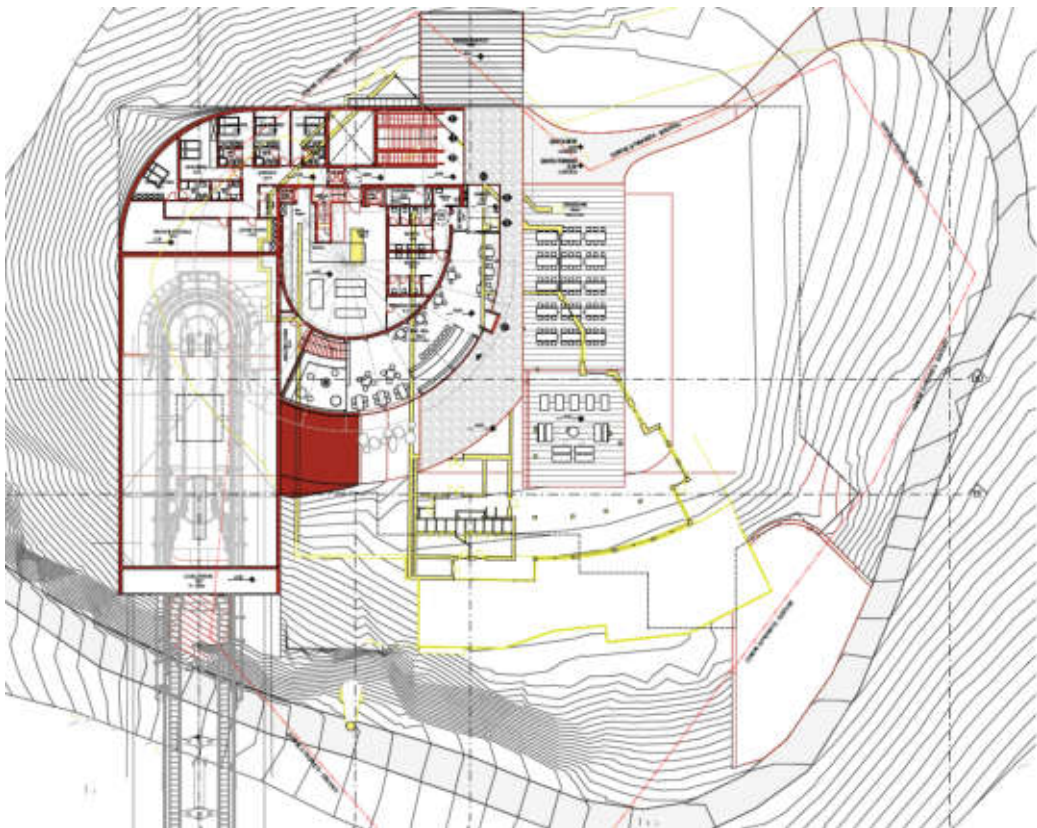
Projektauszug – Grundriss EG Bergstation (Arch. Sader) / stralcio da progetto – pianta piano terra stazione di monte (Arch. Sader)
